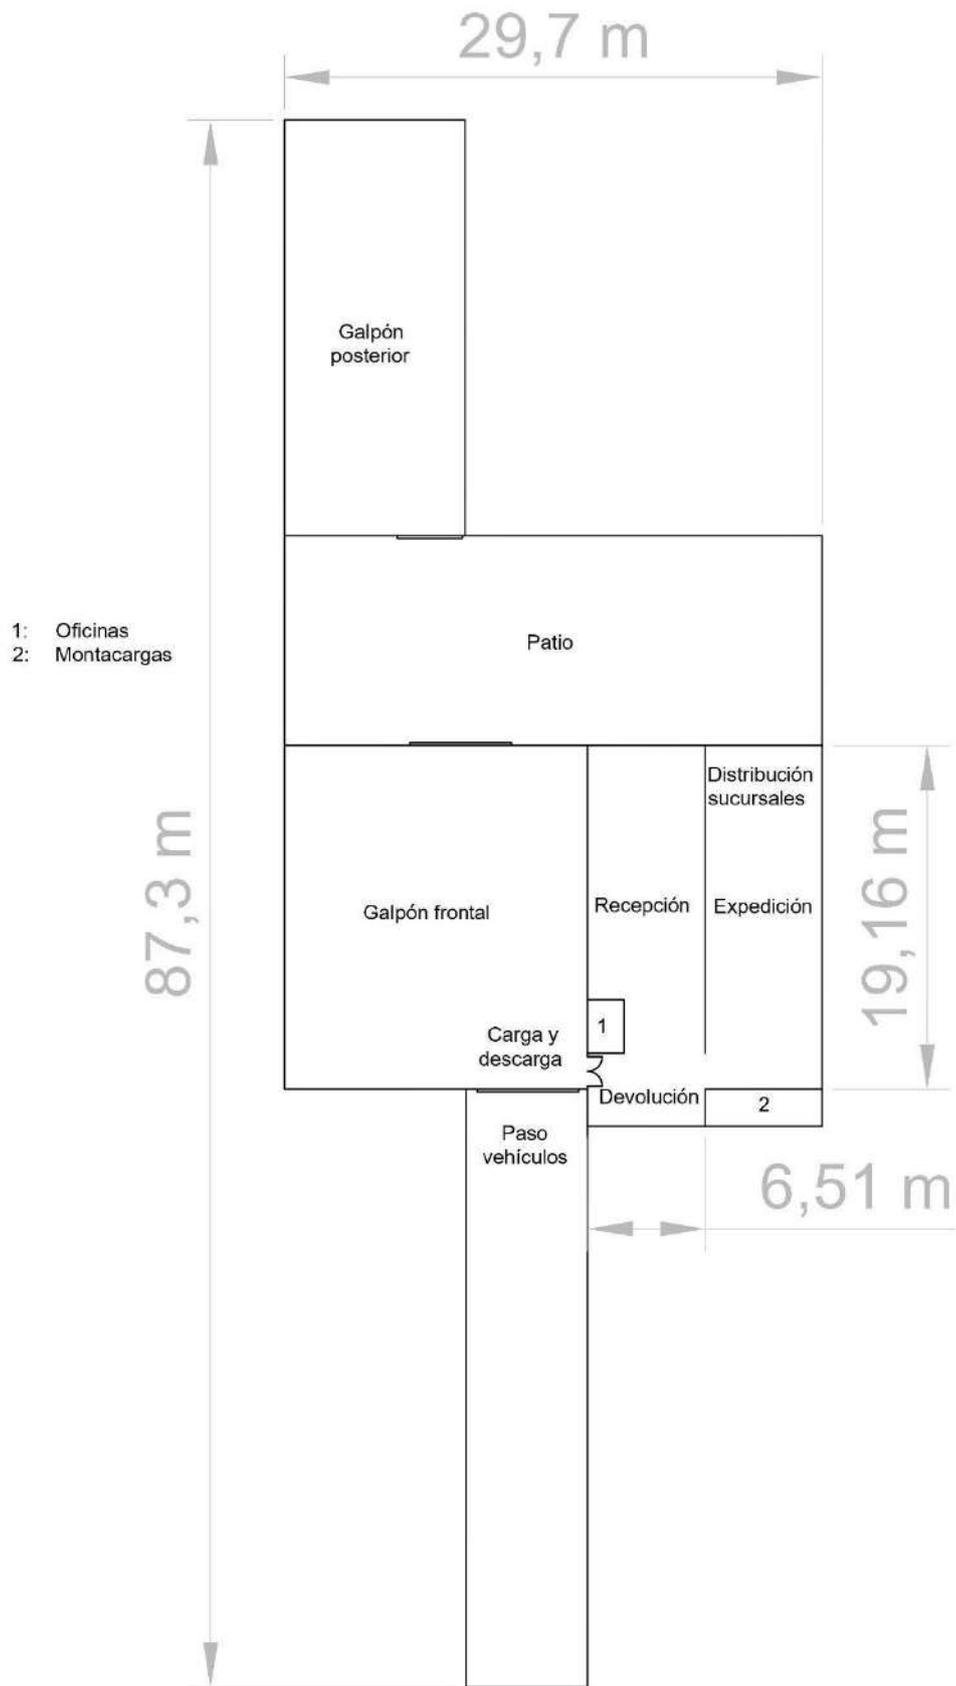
Plano actual de la Planta Baja con los distintos sectores identificados.
